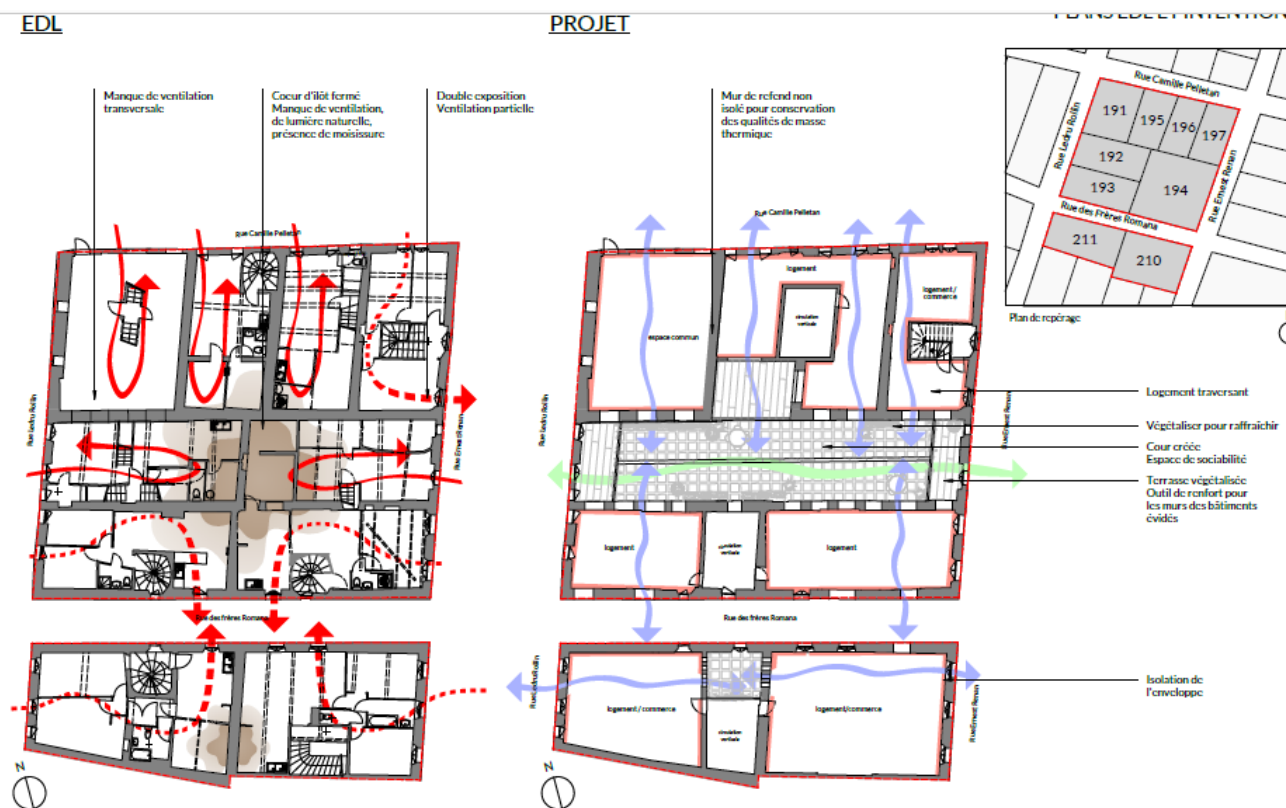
Plan d'aménagement illustrant la création d'une cour intérieure
